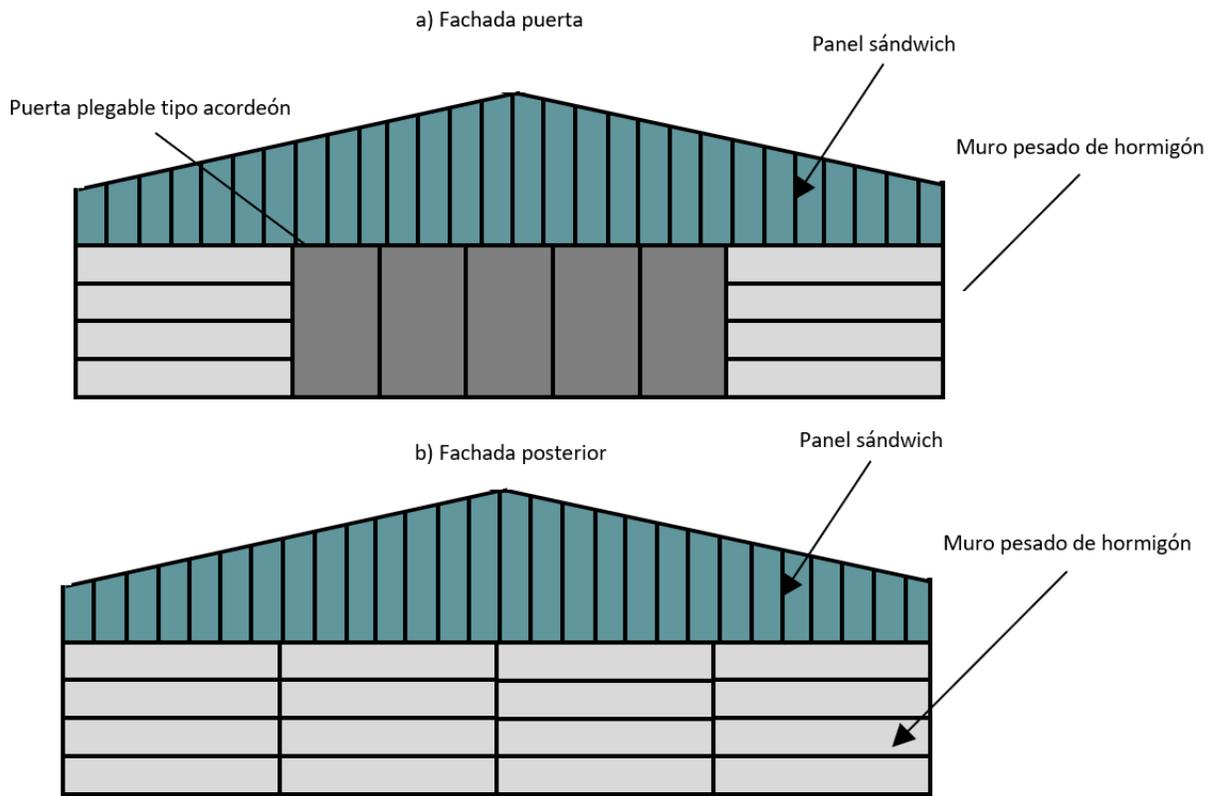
Esquema de los cerramientos de las fachadas puerta y posterior. Elaboración propia.
